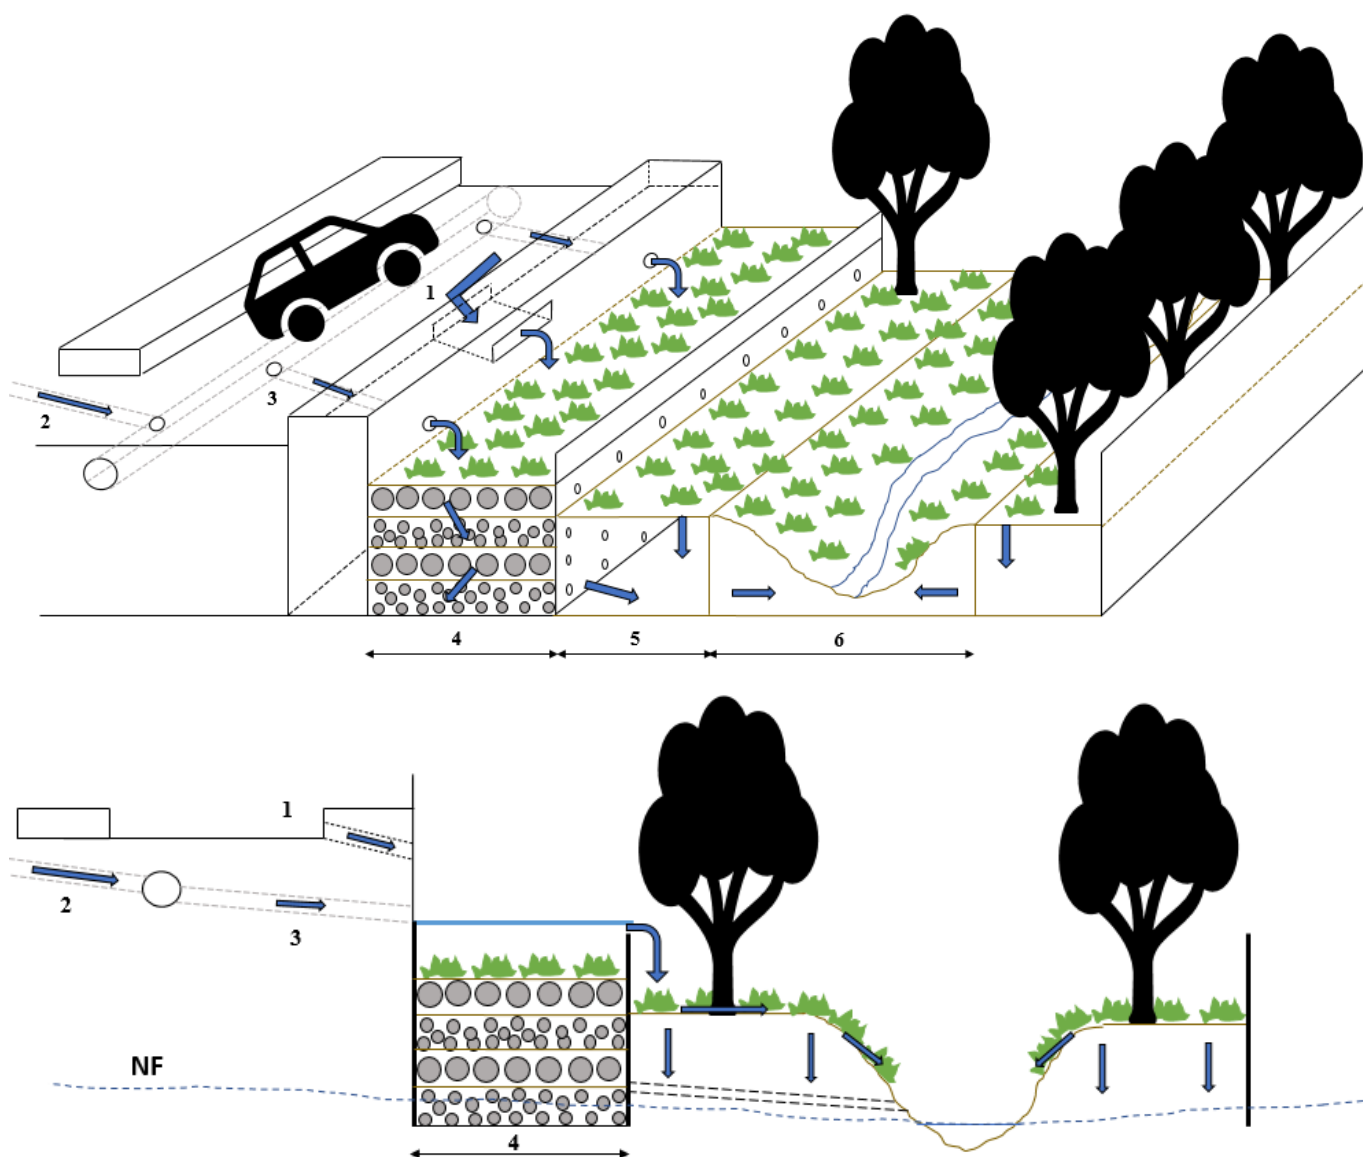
Layout dos STVC construídos da área de APP prevista por lei.
